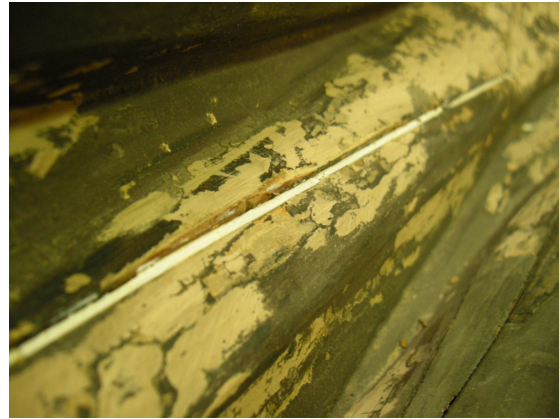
Pormenor do preenchimento das fissuras com madeira balsa e PVA
